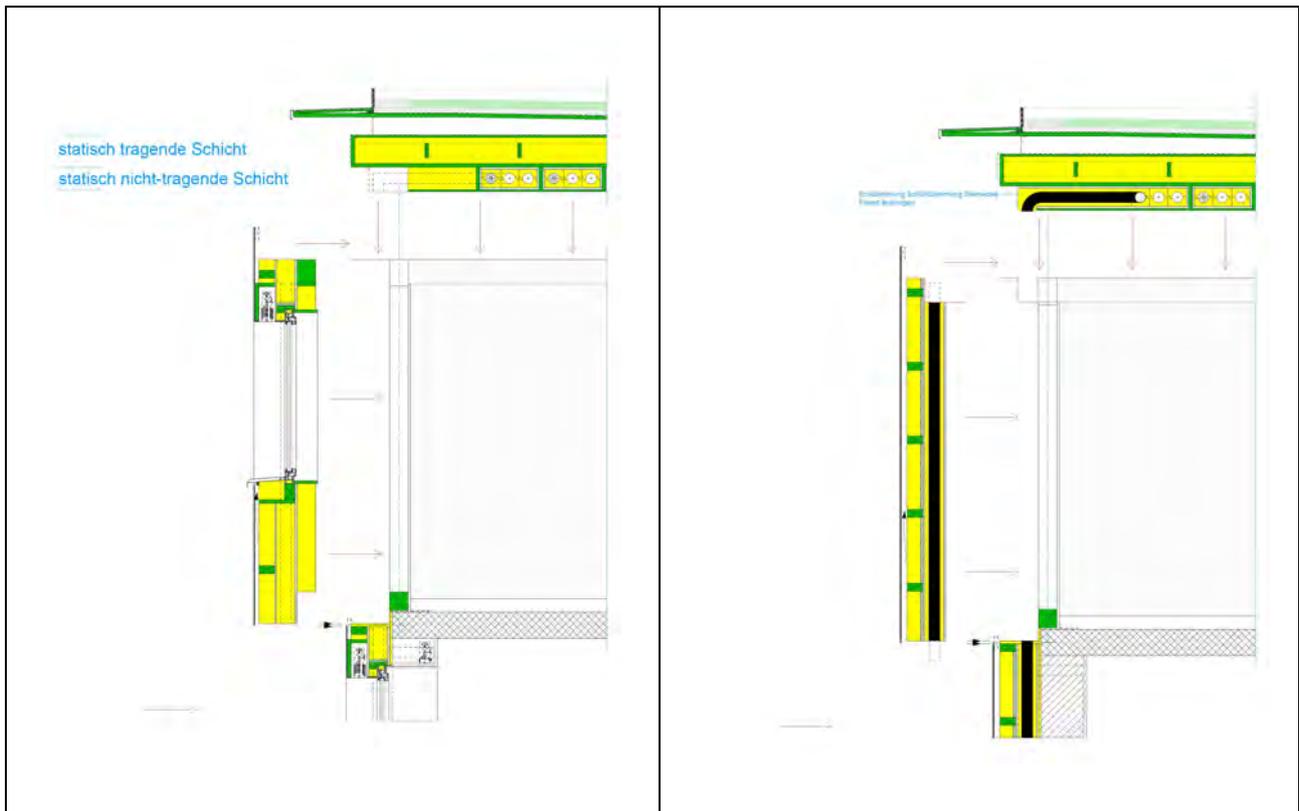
Schnitte Zusammenbau Fassade- und Flachdachelement bei Aufstockung in Leichtbauweise, Bereich Fenster und Bereich Lüftungsleitungen, Abfolge Montage: Ständerkonstruktion, R9, R8
